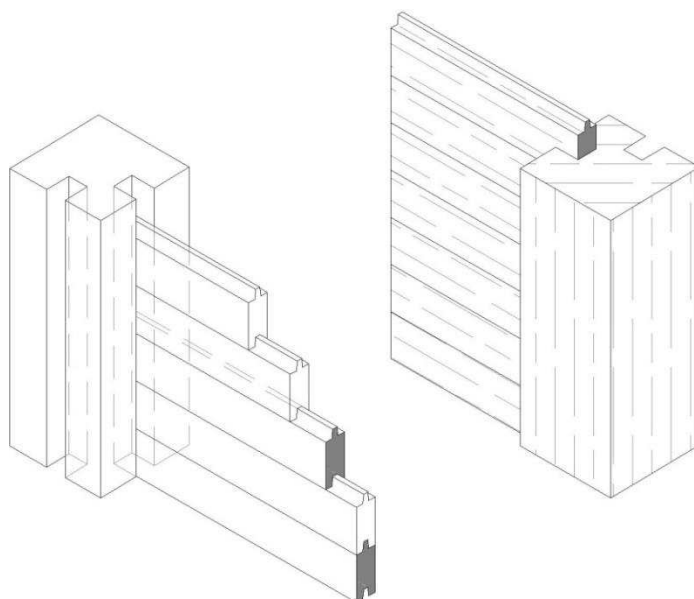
Detalhe de montagem de paredes de vedação e pilar de canto por meio de encaixe.
